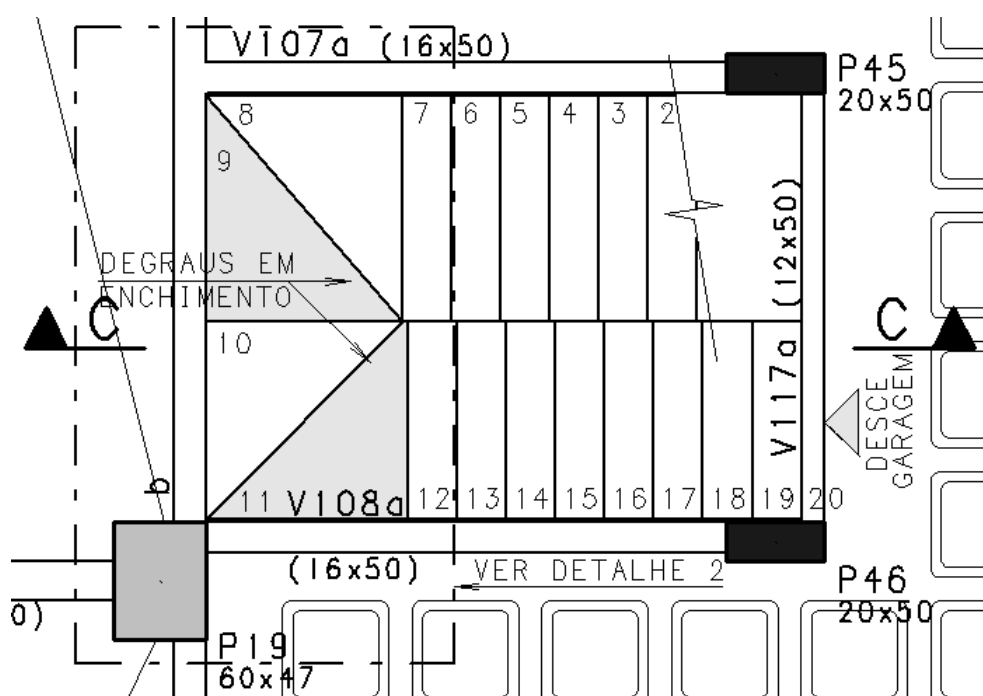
35 - Detalhe da forma do térreo, mostrando a escada 2 em planta.
